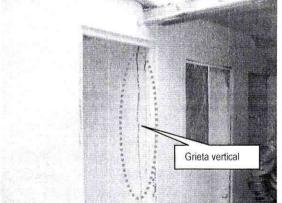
Grieta vertical de aproximadamente 2m de largo y abertura aproximada de 3cm, en uno de los muros divisorios de la vivienda.
